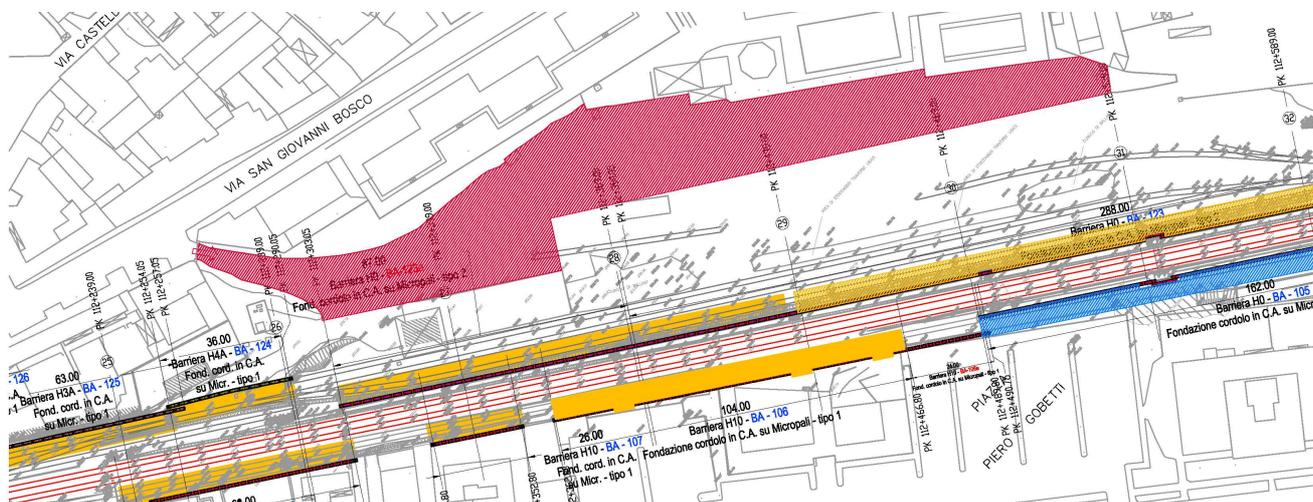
Stralcio planimetrico Area Cantiere Stoccaggio materiali
